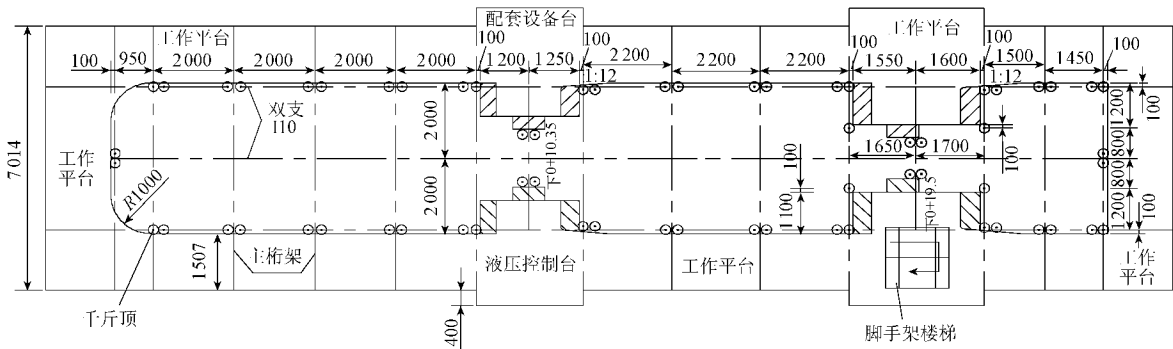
泄水闸闸墩主桁架及千斤顶平面布置(单位:mm)
